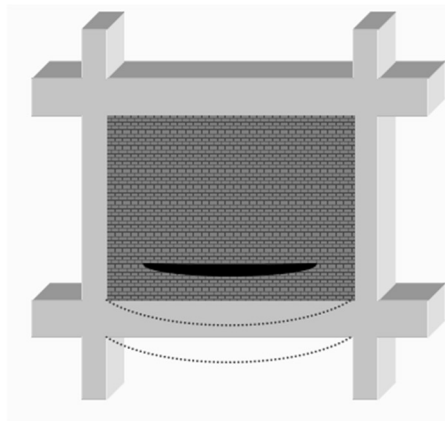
Fissuração horizontal em pano de alvenaria devido a deformação da viga (Araújo,2003)
